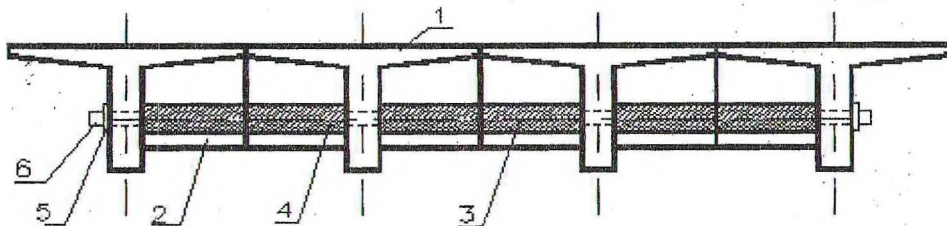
Поперечное обжатие напрягаемым арматурным элементом или пучком, закрепляемым после натяжения обетонировкой между стенками балок: 1 – балка; 2 – полудиафрагма; 3 – арматурный стержень или пучок; 4 – бетонная рубашка; 5 – упорная шайба; 6 – анкер
